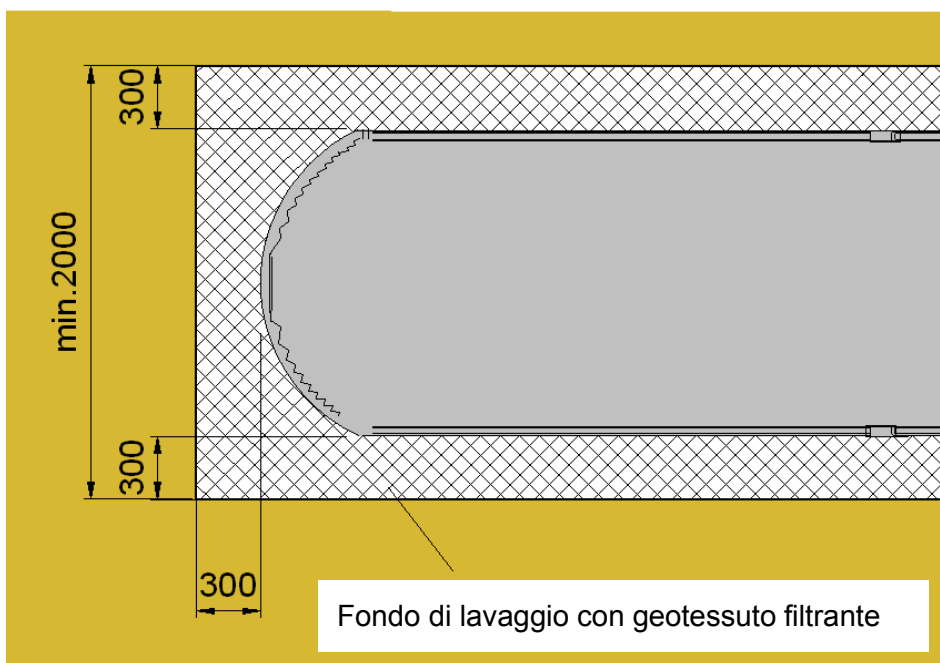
Geotessuto filtrante alla base del tunnel di lavaggio
